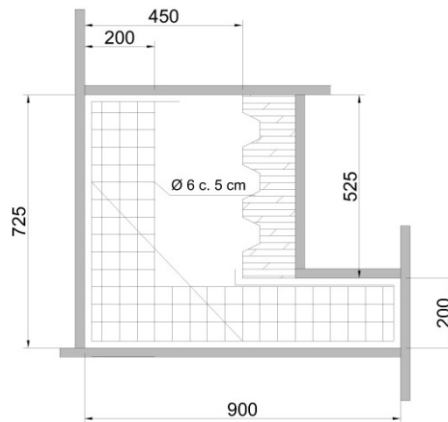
Disposición de la malla electrosoldada para evitar la fisuración superficial durante la manipulación de las piezas de hormigón para la junta de tres llaves (dimensiones en mm)
